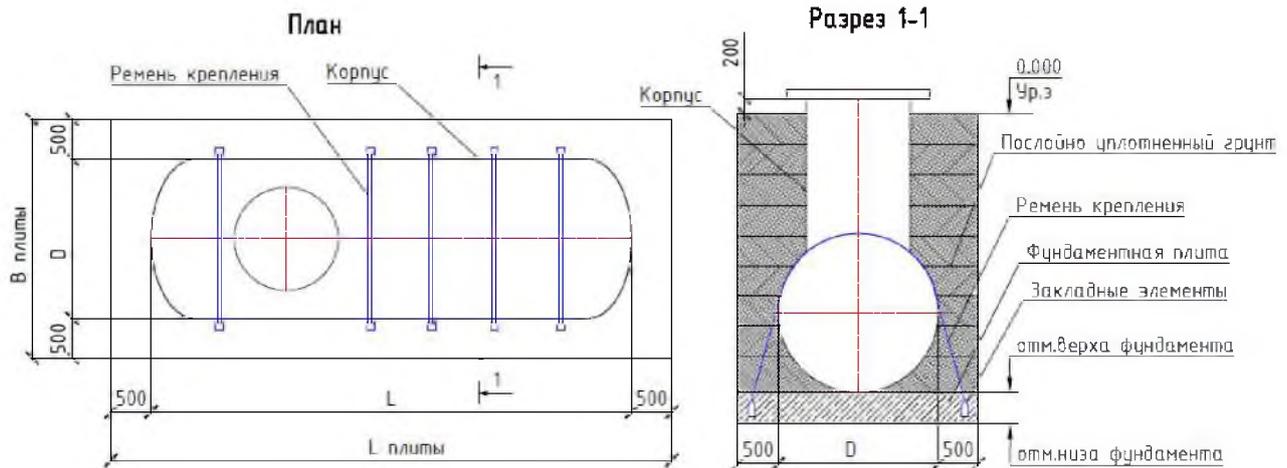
Пример монтажа оборудования при высоком уровне грунтовых вод
